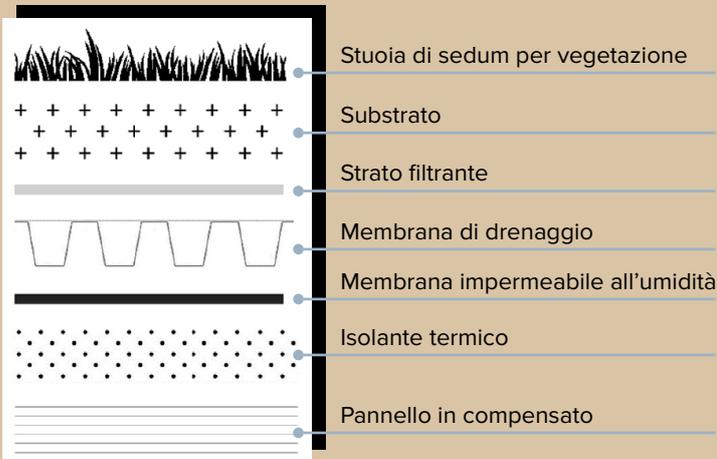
Sezione orizzontale del pavimento che separa le due stanze di prova su cui è posizionato il modulo del tetto verde estensivo
